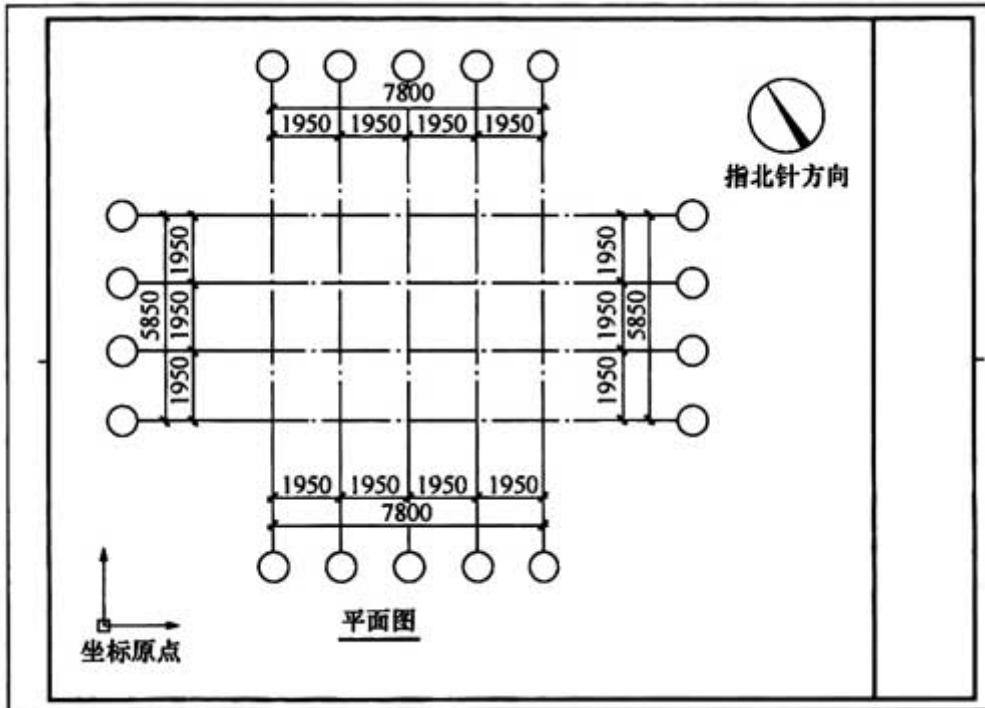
0. 1-1 正交平面图制图方向与指北针方向示意
